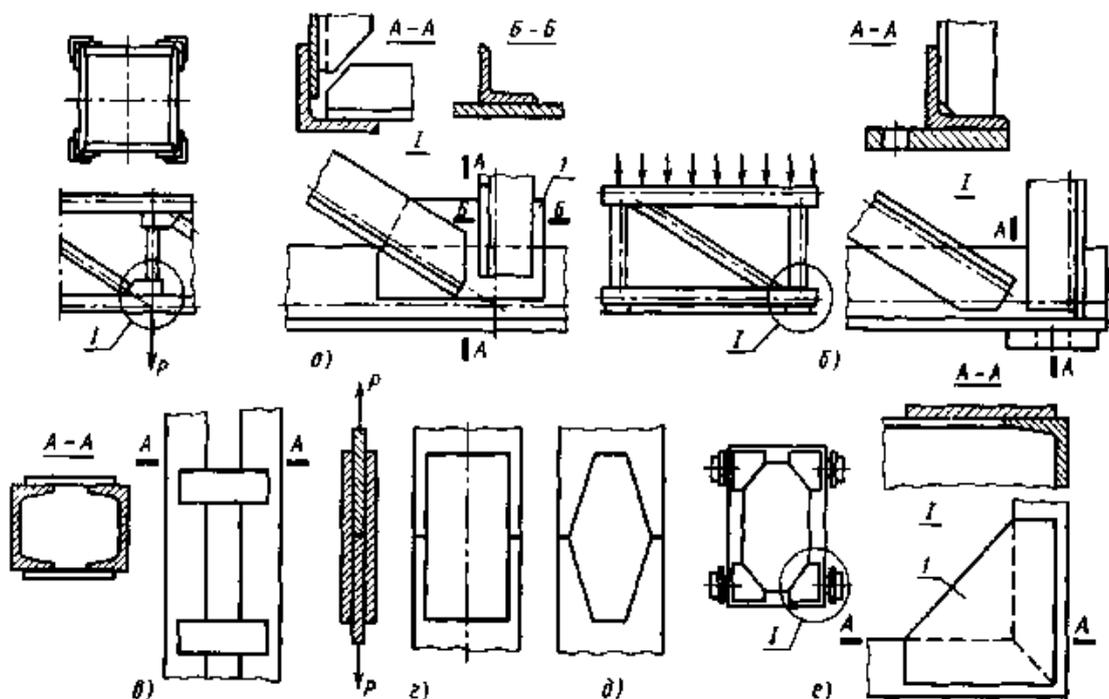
Примеры установки накладок и косынок в сварных конструкциях
